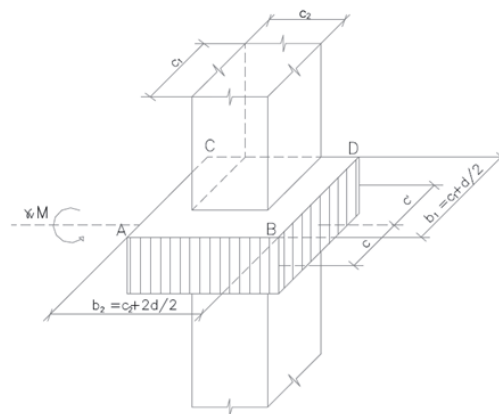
NOMENCLATURA, PARA EL CÁLCULO DEL PUNZONAMIENTO DE LOSAS PARA UNA COLUMNA INTERNA.
